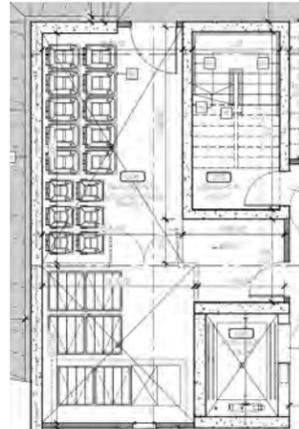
Salle à déchets de 559 pi<sup>2</sup> située au sous-sol
